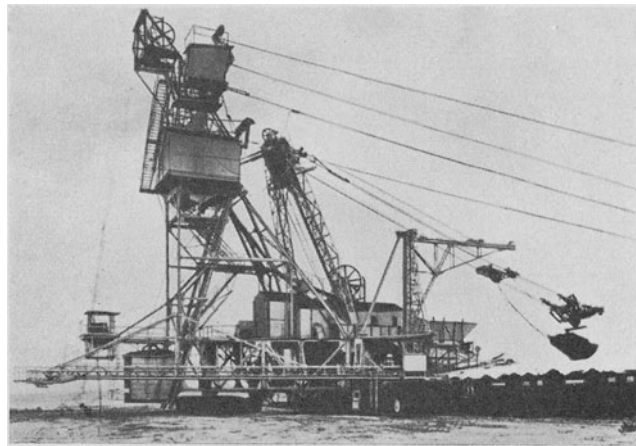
Maschinenturm eines Kabelbaggers beim Kohlenfördern
